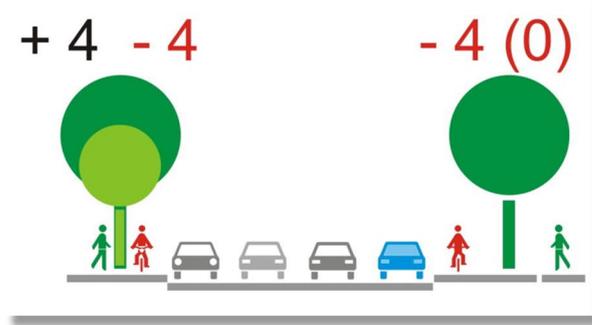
Abschnitt B2 – Baumbilanz (Klammerwert: mit Grunderwerb)
